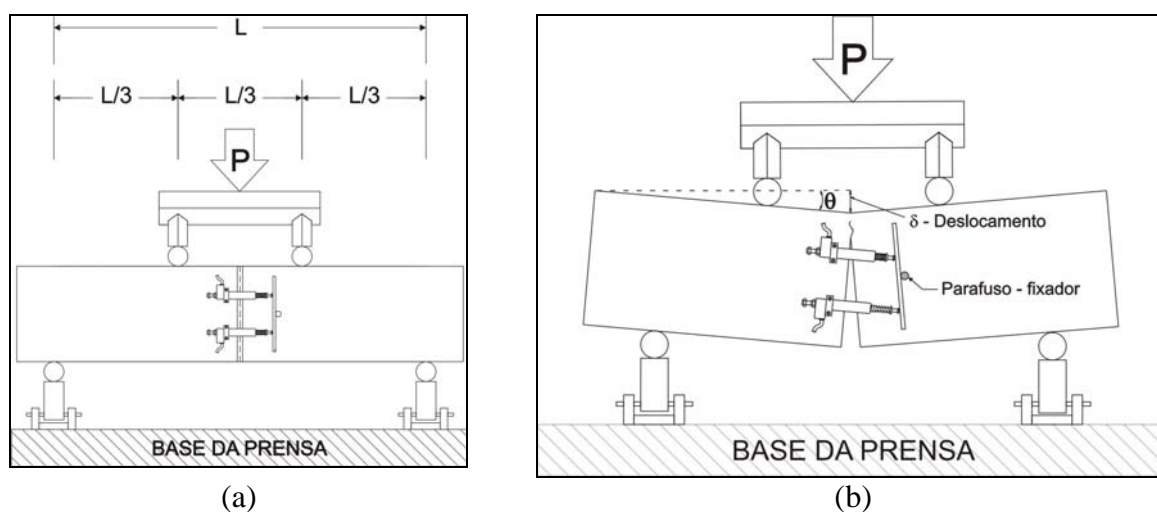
Esquema do ensaio de flexão a quatro pontos de vigas (a) configuração do ensaio; (b) movimento de corpo rígido da viga durante o ensaio.
